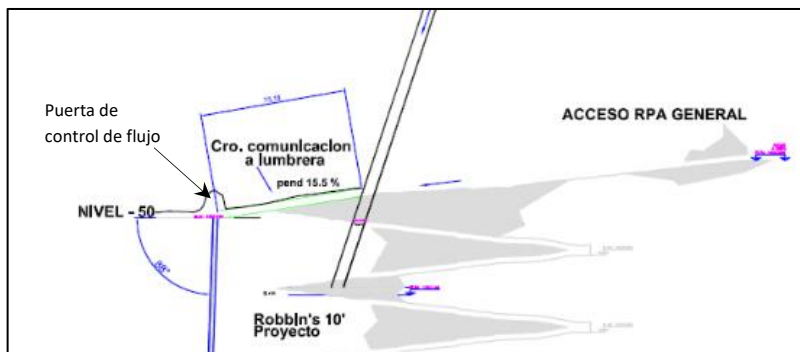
Sección general del proyecto, ubicación de tapón y puerta
